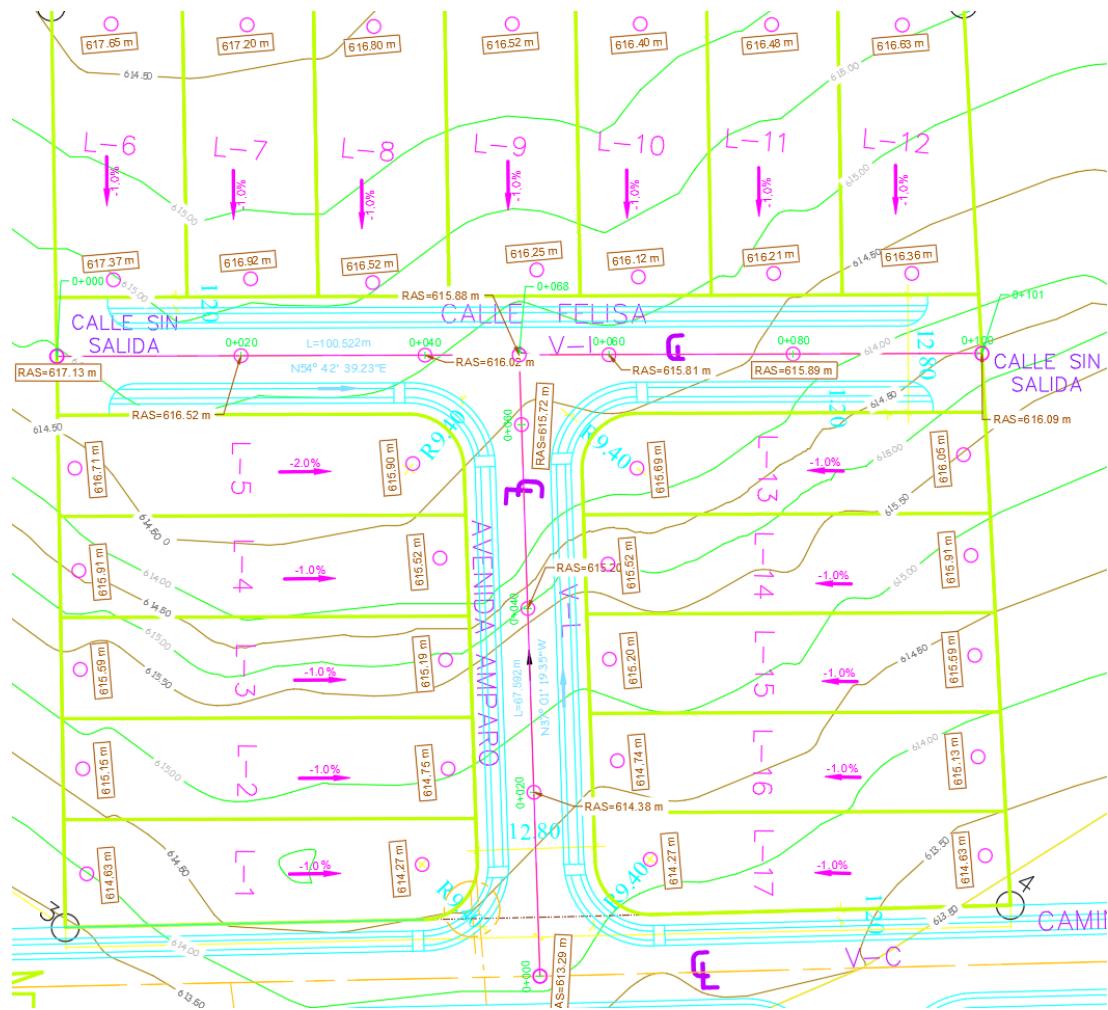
Niveles de terracería sobre planta de lotificación (Lote 1 al 17)
